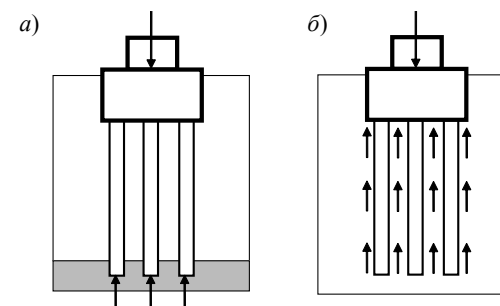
Виды свайных фундаментов: а – фундамент на сваях-стойках; б – то же на висячих сваях
